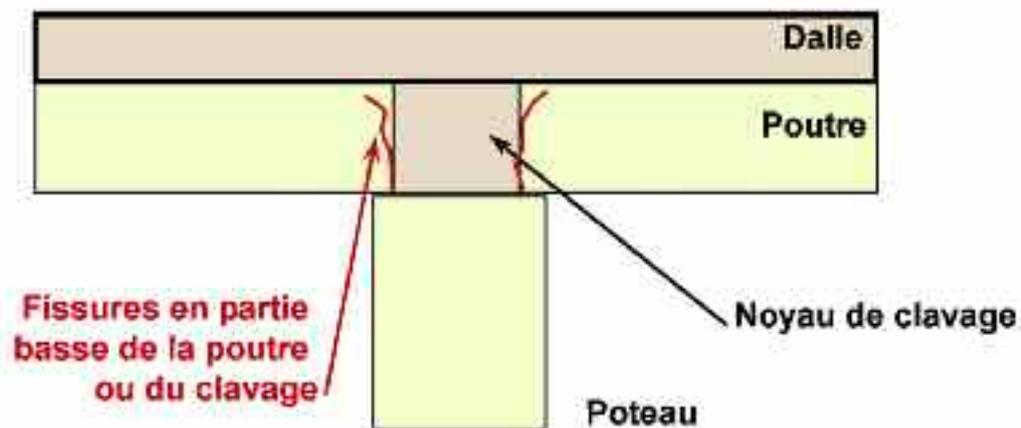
fissures sur appuis intermédiaires de poutres PRAD
